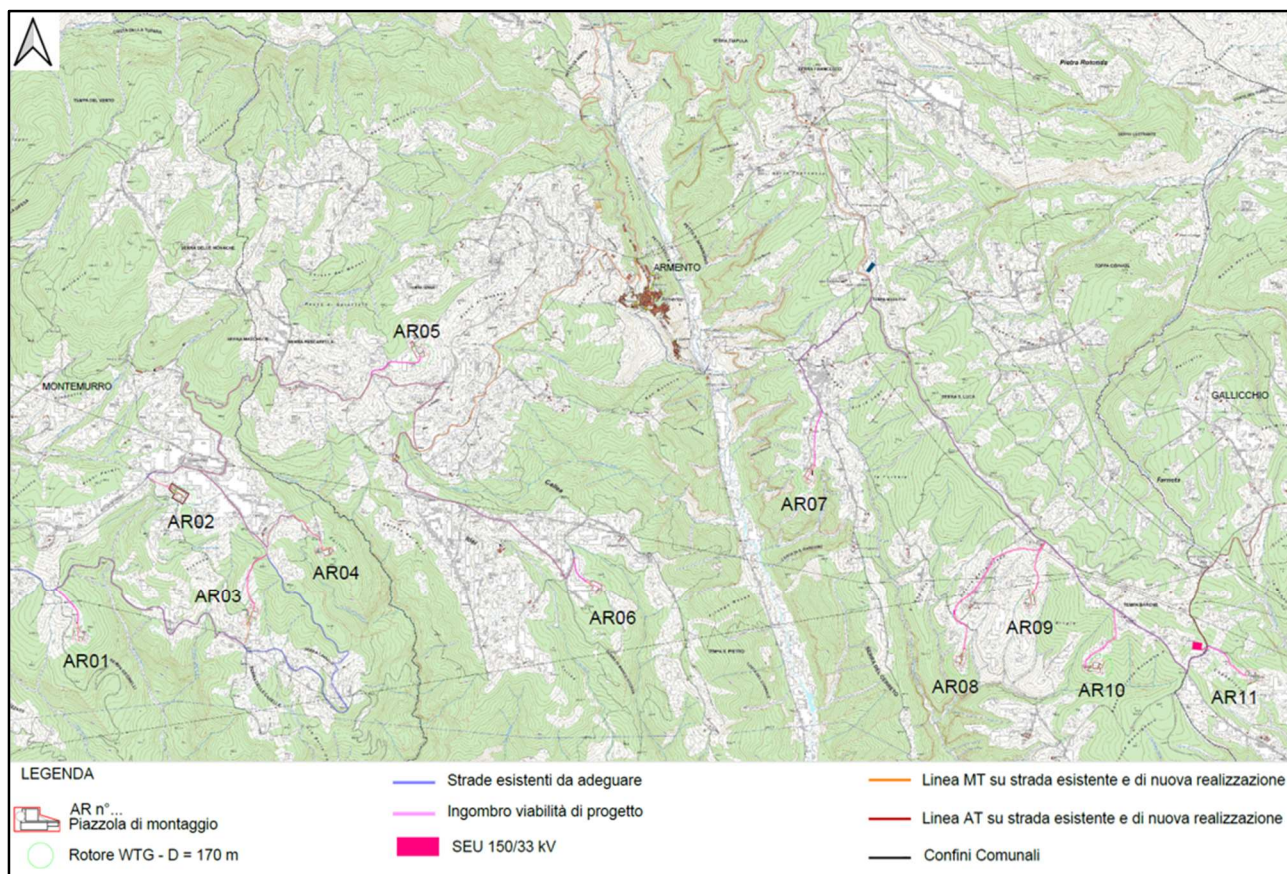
Layout d'impianto con viabilità di progetto e linee elettriche MT su CTR
